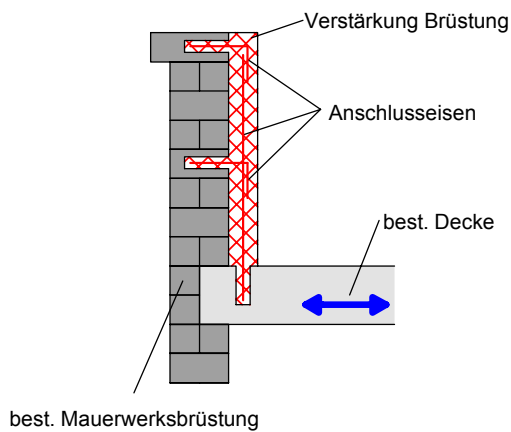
> Nachträgliche Sicherung einer Mauerwerksbrüstung mit Stahlbeton
